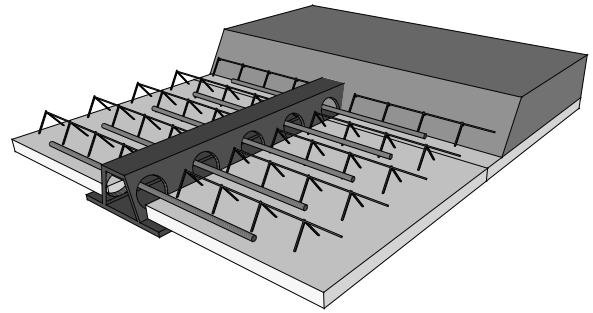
Konstruktionschema Slim-Floor Decke mit Elementplatten
